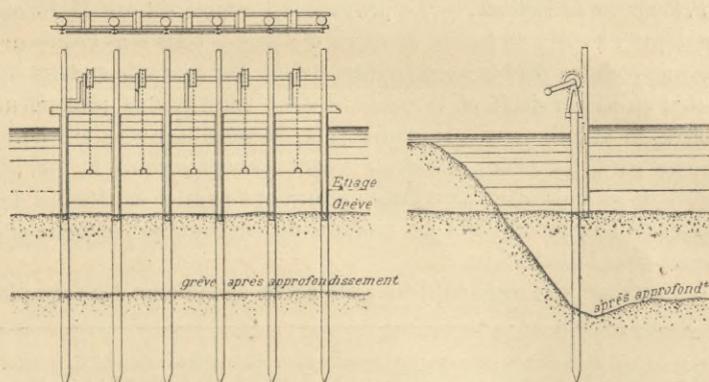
, 18 et 19. — Plan, élévation et coupe d'un barrage mobile proposé par M. Audouin.
